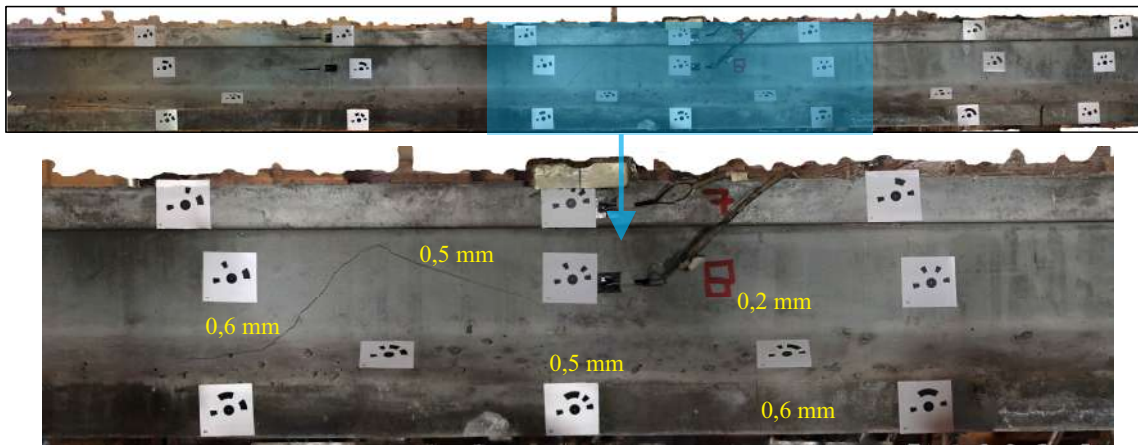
Fissuras no último ciclo da viga UHPC-P-Flex-Cis
